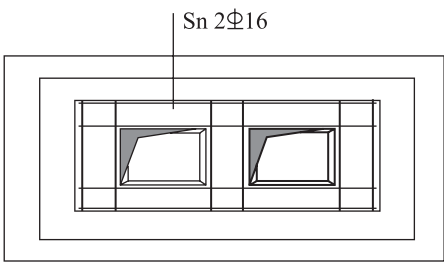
双杯口独立基础顶部焊接钢筋网示意图
